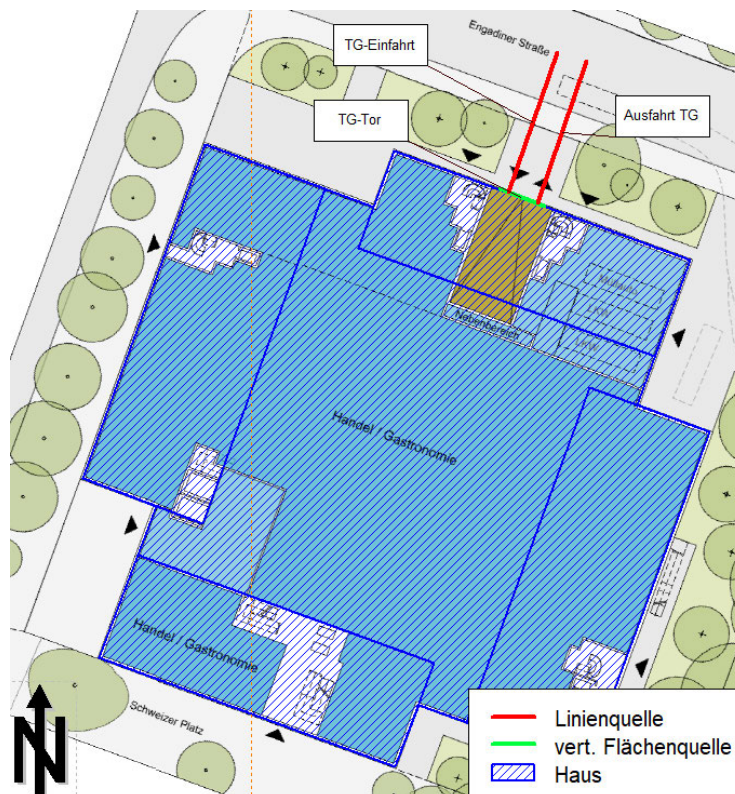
Lageplan [1] mit Schallquellen TG-Zufahrt bzw. -Ausfahrt (ohne Maßstab)
